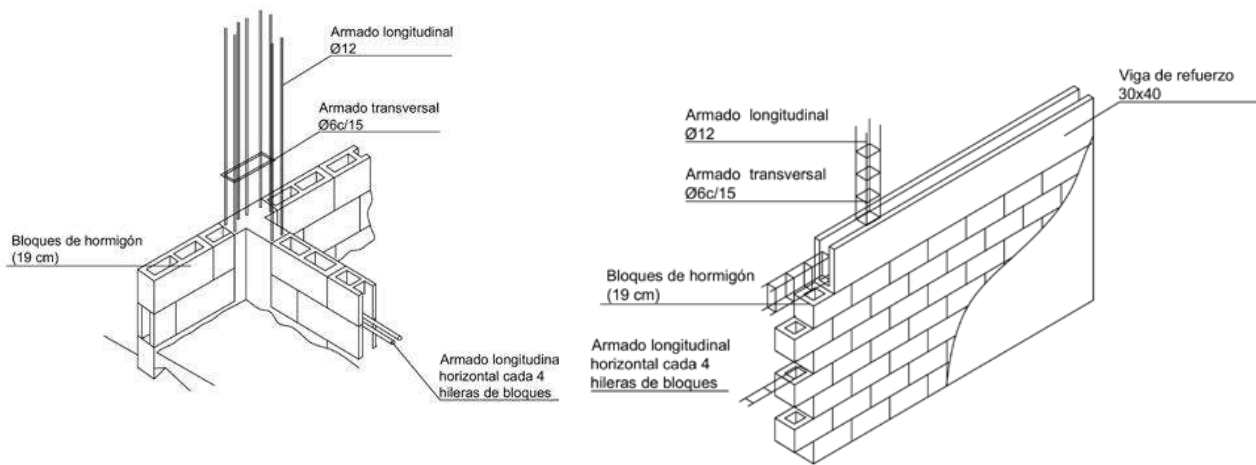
Sistema constructivo de bloques de hormigón. Fuente: Informes de la Construcción, Department of Engineering and Building Management, University of Talca, Curicó (Chile). 2021.
